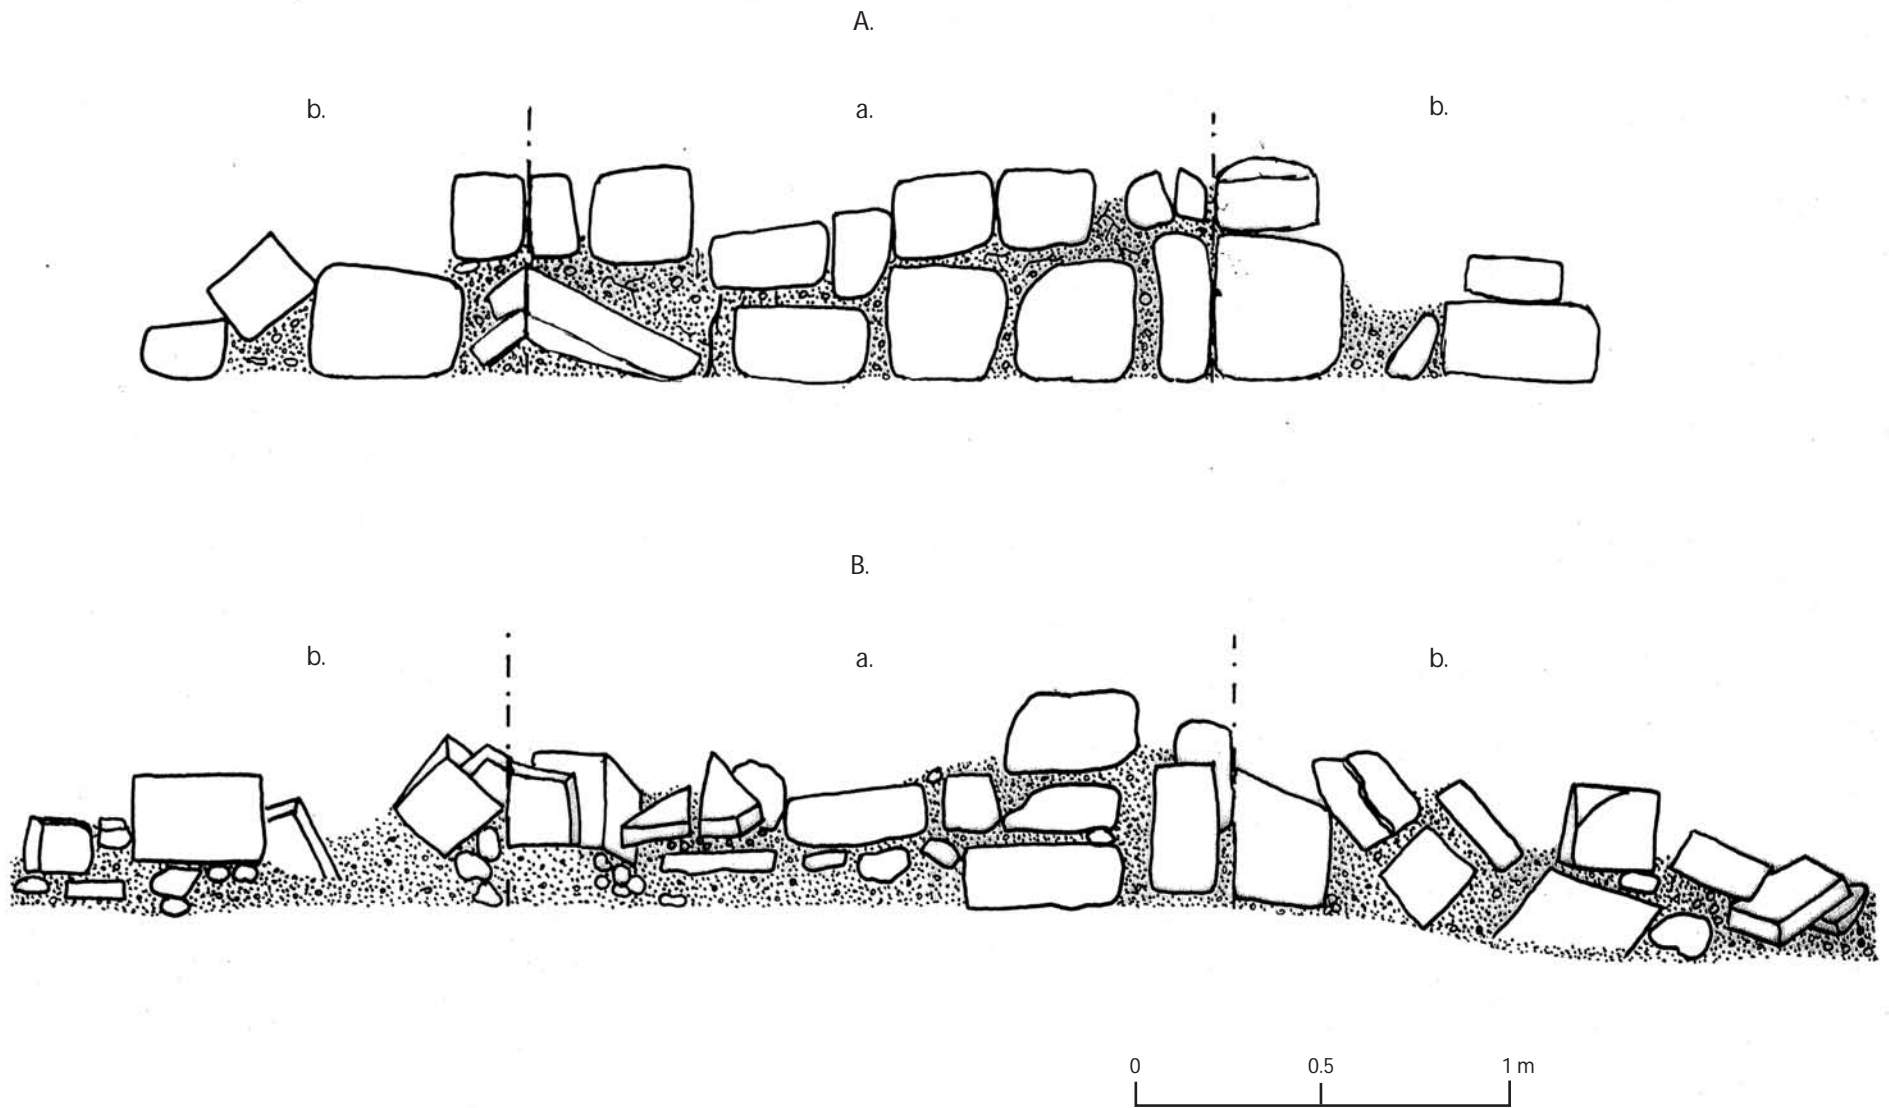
Arranque de los muros de los edificios en la cima de la Estructura 2, última fase constructiva. A) CK01D-04-01-70 y 72, muro frontal central, a) cara interior, b) laterales. B) CK01D-14-01-87, muro frontal lado suroeste, a) cara interior, b) laterales (dibujo Fabiola Quiroa).
